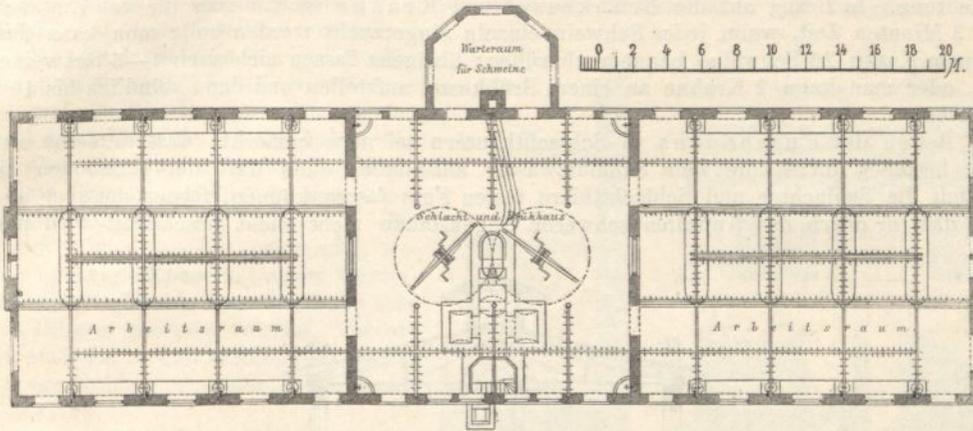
Grundriss der Schweine-Schlachthalle zu Graz.
